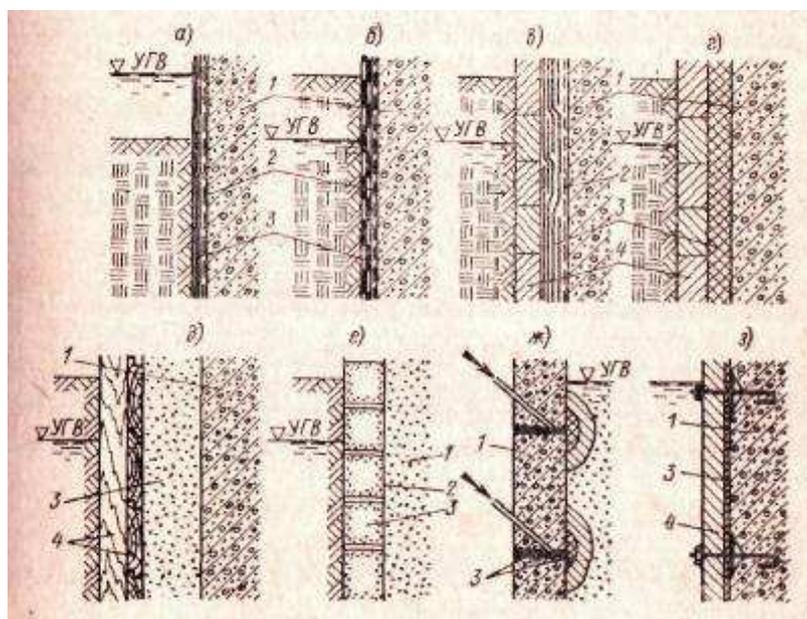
Типы поверхностных гидроизоляционных покрытий (к п. 1.13)
